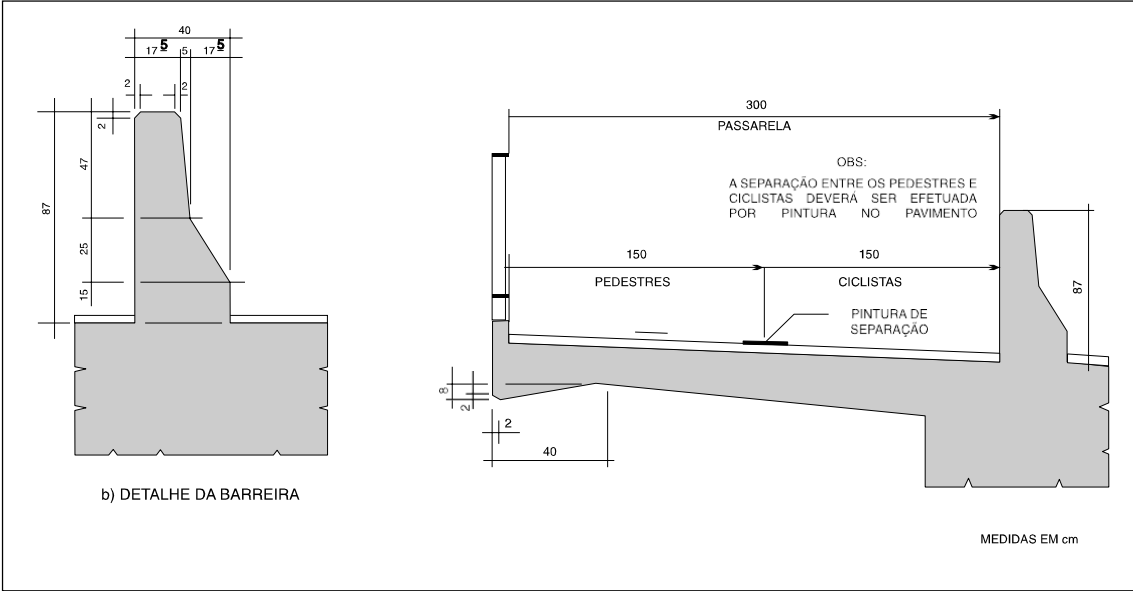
SECÇÃO TRANSVERSAL FAIXAS DE PEDESTRES E CICLISTAS
